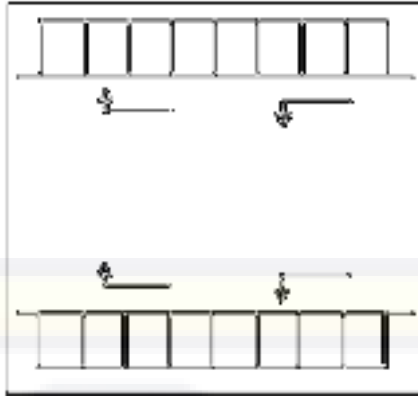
Pola Parkir Sudut yang Berhadapan
